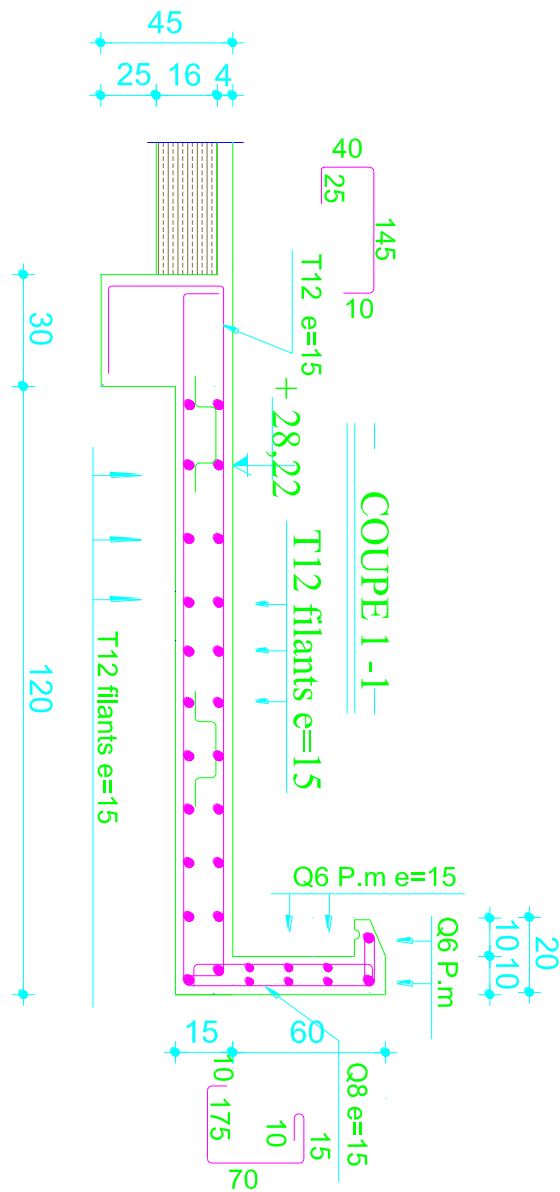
Coffrage et ferrailage des balcons Terrasses
